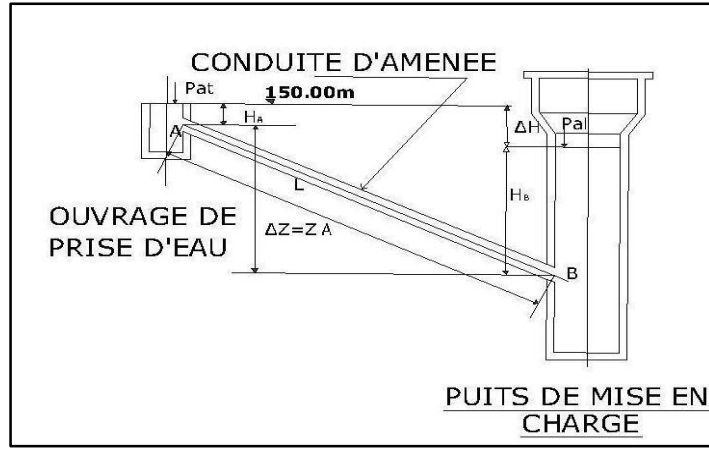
conduite d'amenée entre ouvrage de prise d'eau et puits.
